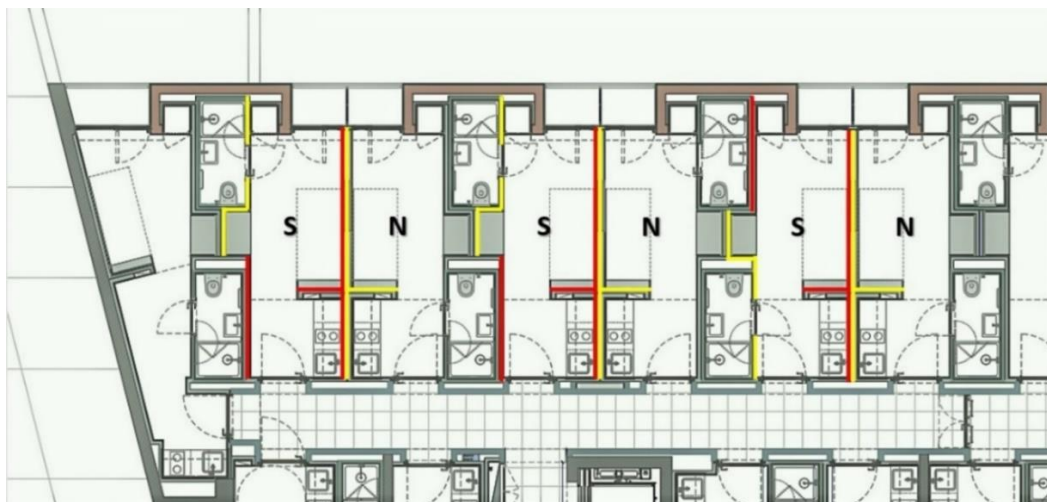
Áreas de intervenção Fase 2 - Zona amarela (Adaptado de: Planta Piso Tipo – Anexo V)
